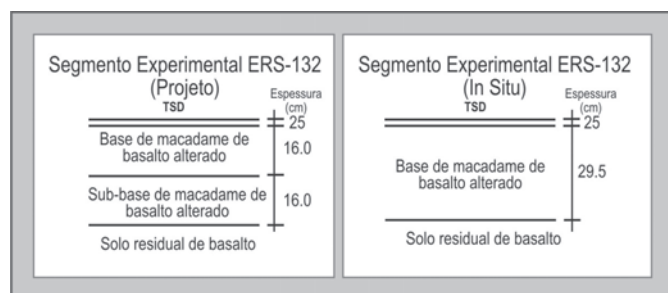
Estrutura do pavimento prevista em projeto e encontrada in situ
